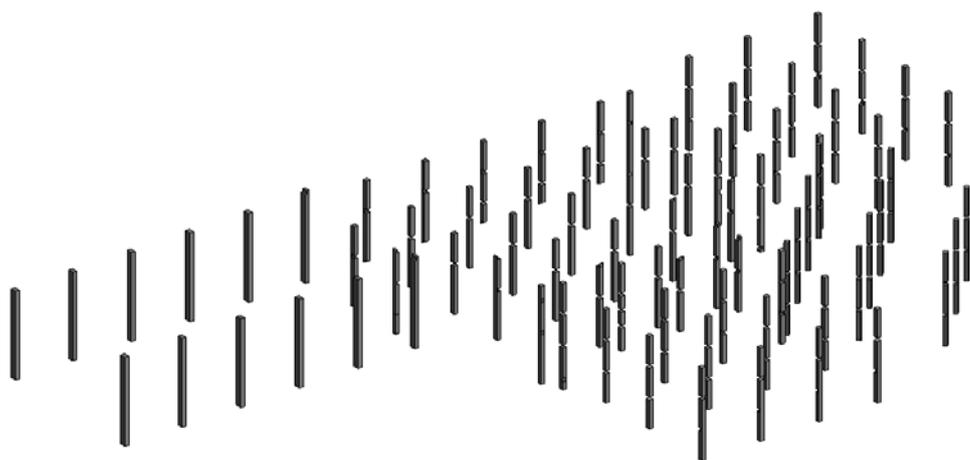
Pilastri in vista 3D (Fonte propio)
